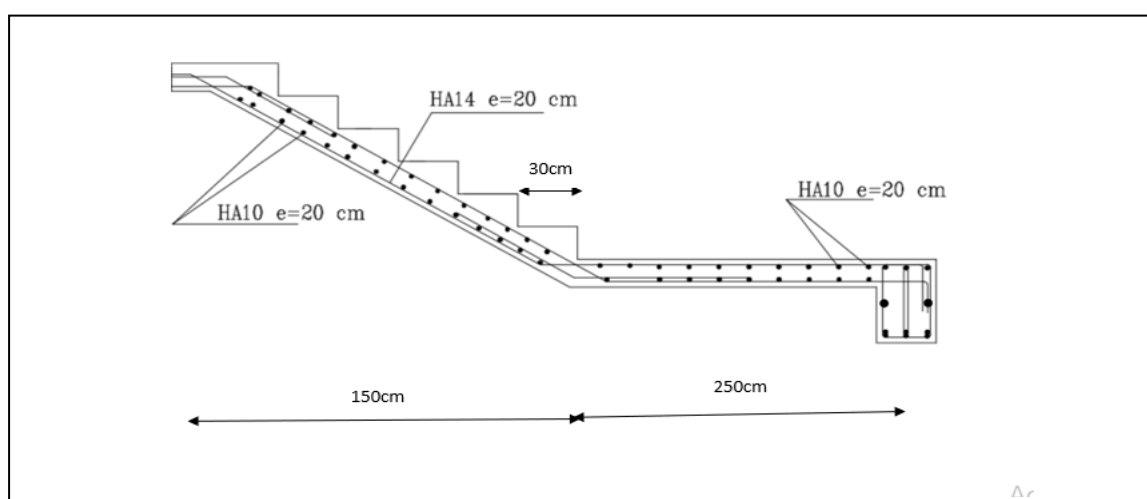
Schéma ferrailage de l'escalier (paillasse1)
